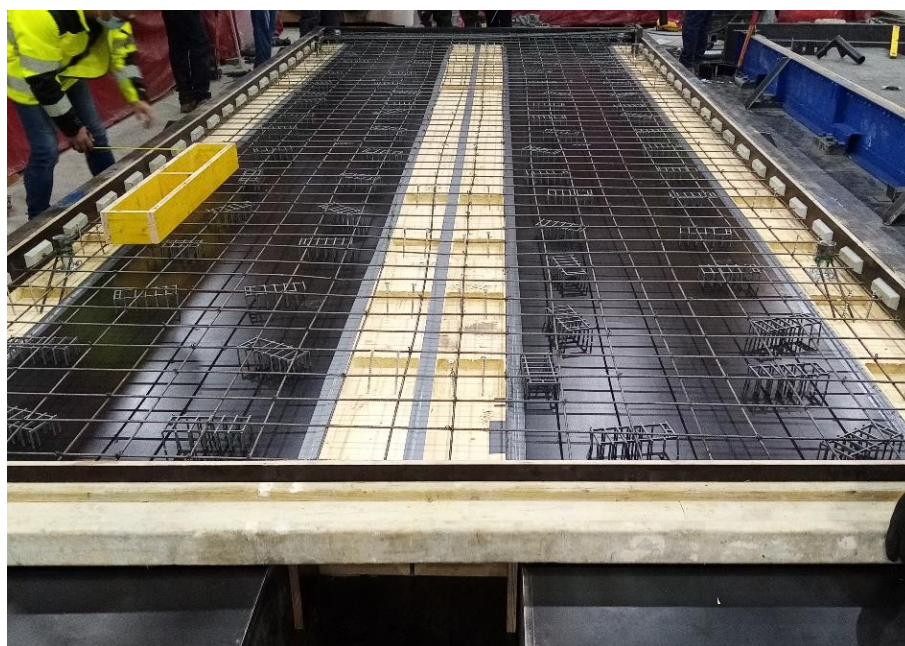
Produção do painel de laje - Colocação da armadura
